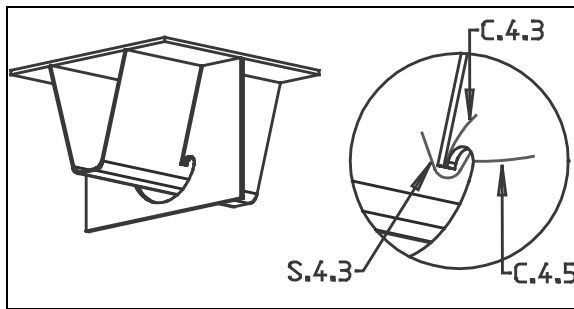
Durchgehende Trapezsteife mit Haibach Aussparung
